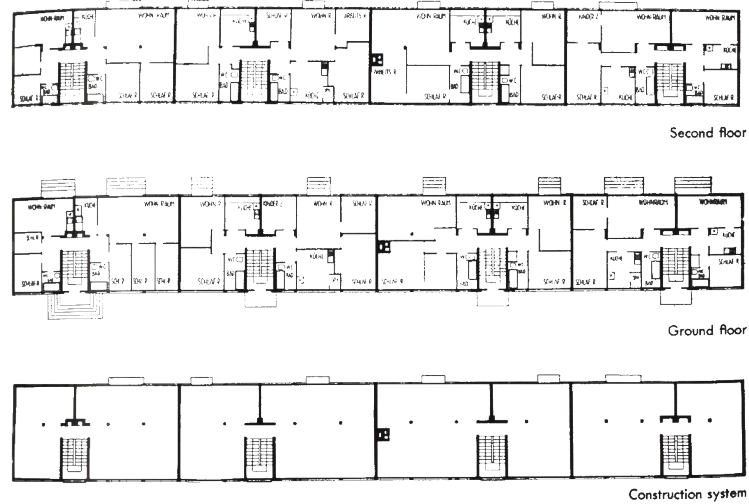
Grundrisse Weißenhofsiedlung
